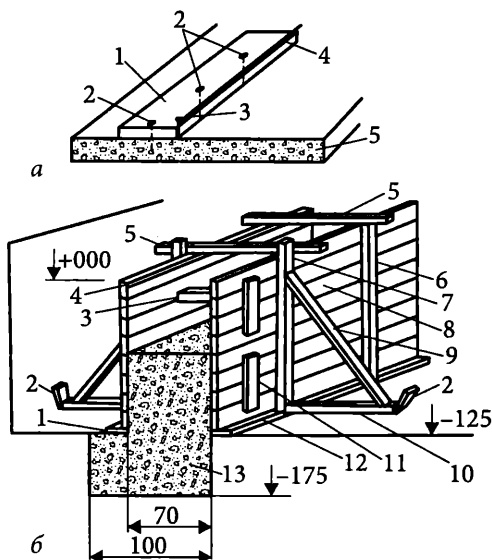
Устройство бутобетонных стен надворных погребов:
